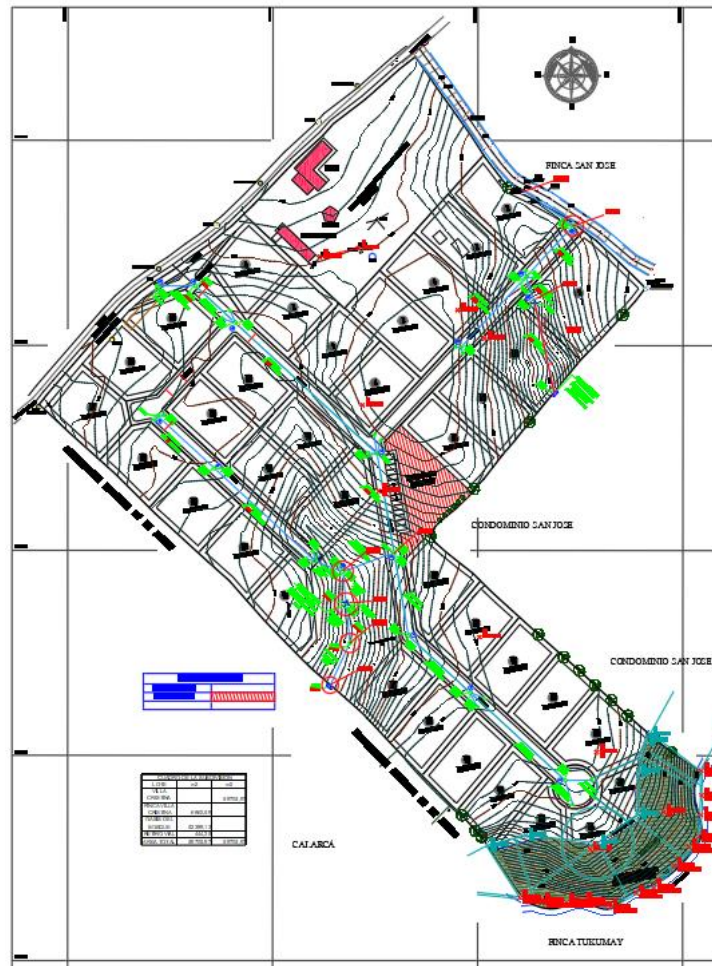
Plano de planteamiento urbanístico del proyecto
